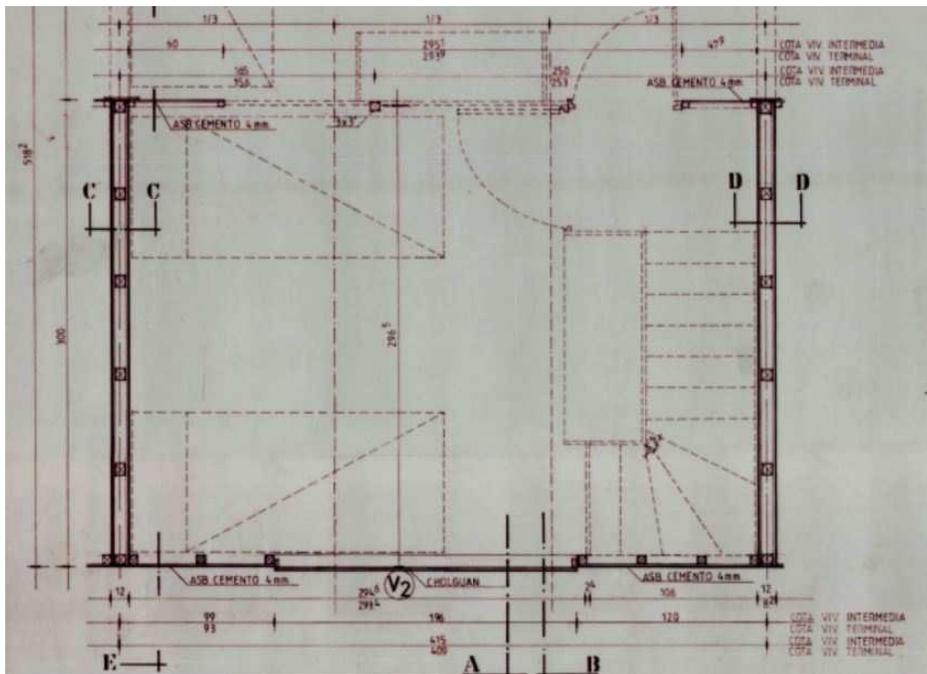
y 59: Planta de vivienda tipo y descripción del programa interior.
